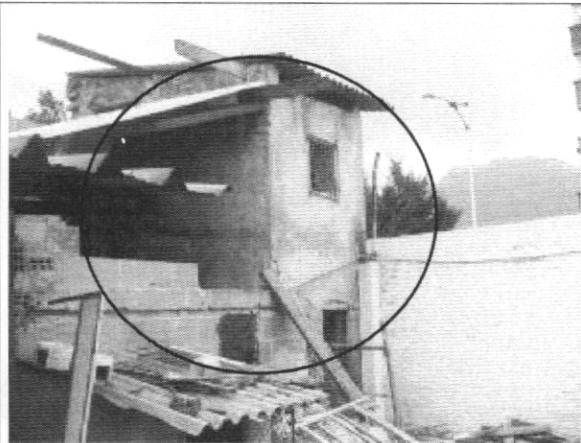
Construcción en mampostería zona posterior, desprendimiento de unidades de mampostería
